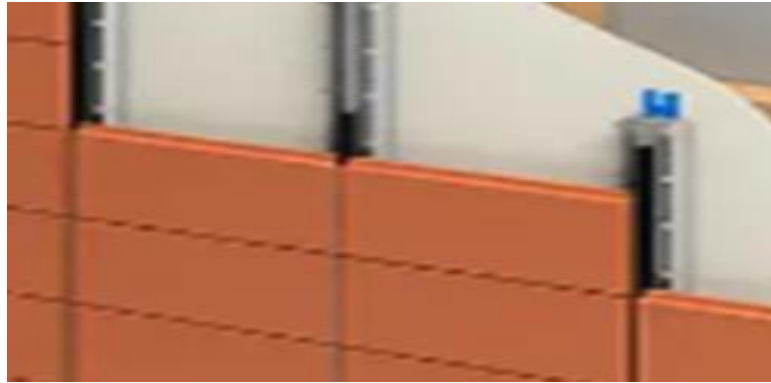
Фрагмент утеплення стіни методом вентильованого фасаду.
